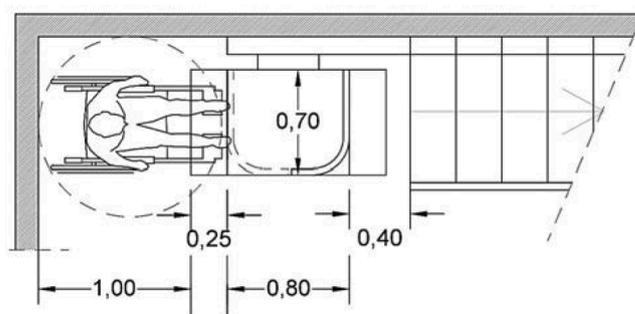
4. Previsión de espacio en el interior de la vivienda para instalar una plataforma elevadora inclinada
